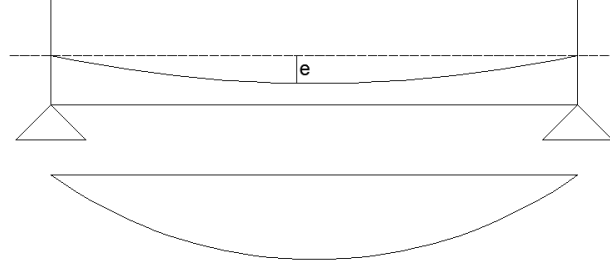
Öngerilmeli ve betonarme bir kirişin davranışı (Hüsem, 2016)
